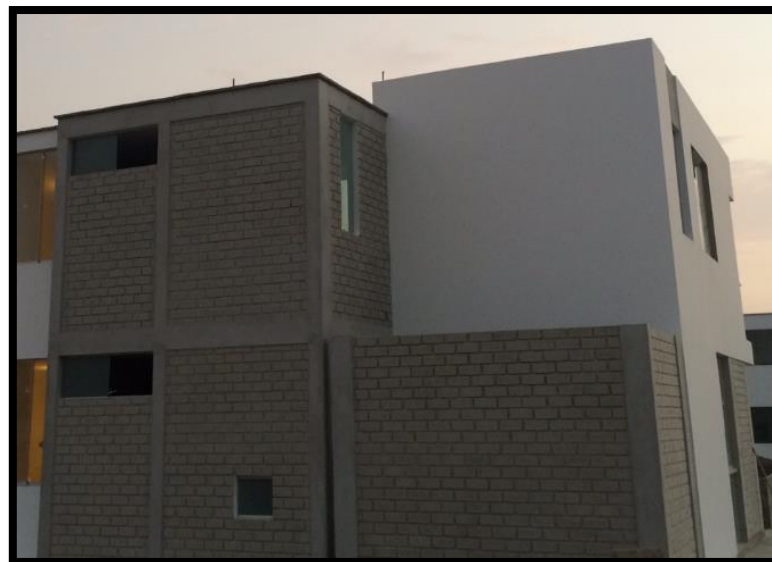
Casa de dos niveles construida con ladrillos de concreto
